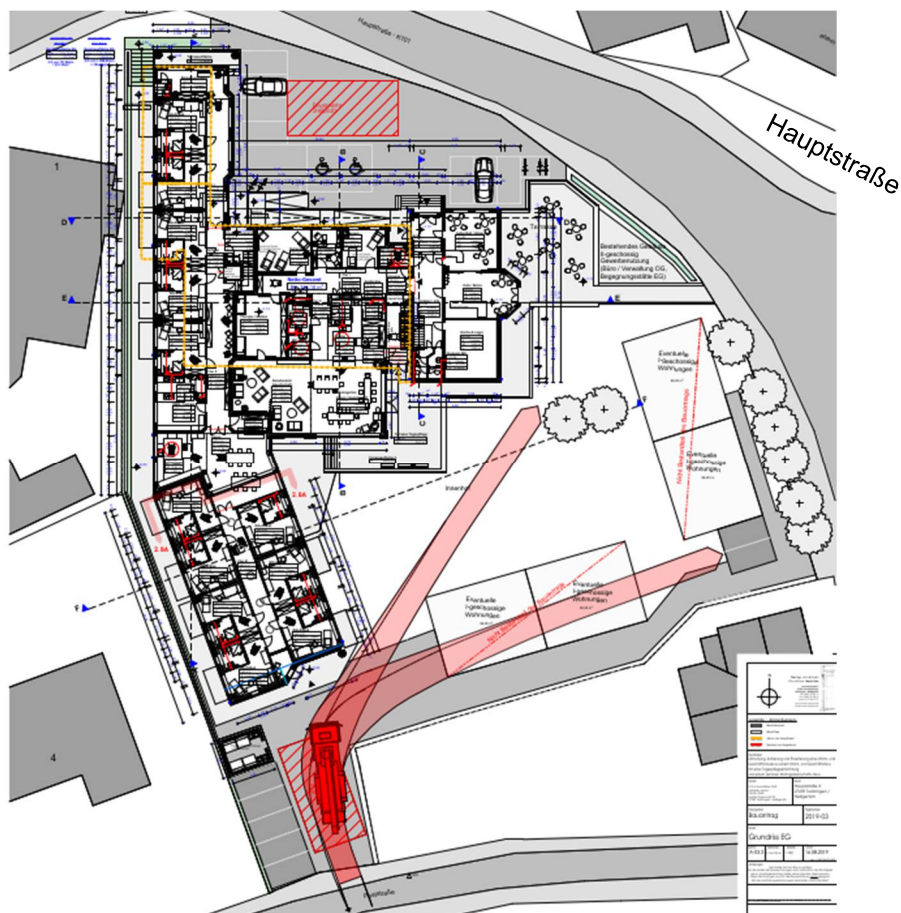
Grundriss EG des Vorhabenkonzeptes des ehemaligen „Bollweg“-Geländes
